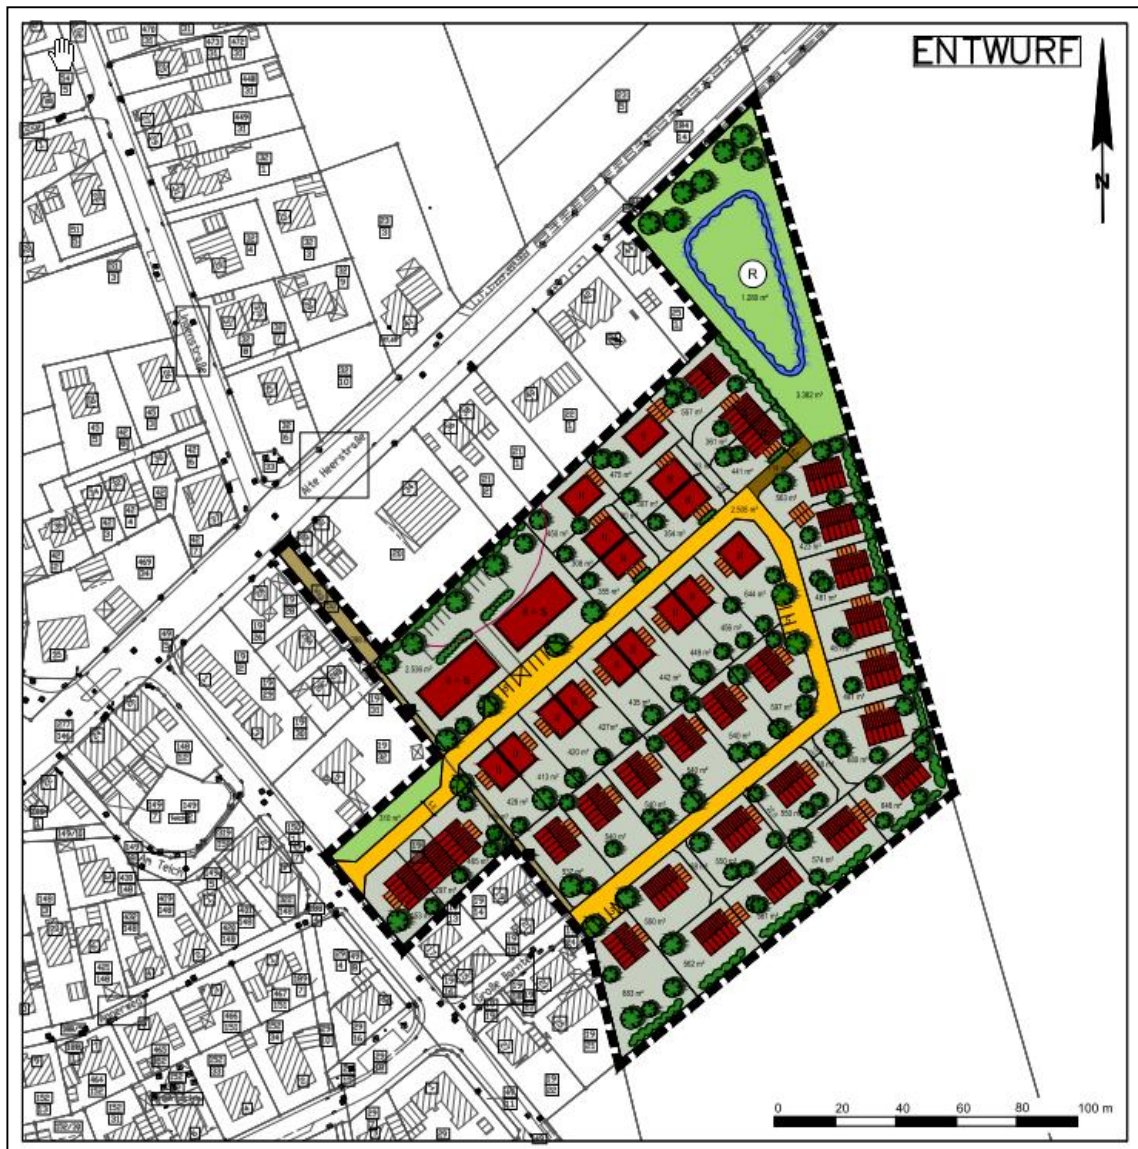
Lageplan Plangebiet B-Plan EN 183 „Große Barnte“ (Quelle: Google Maps)
